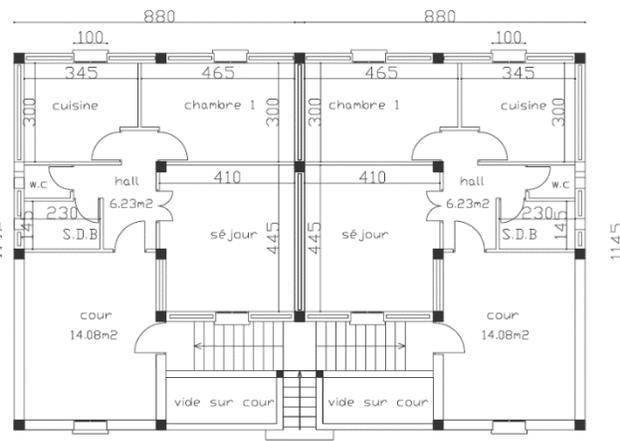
PLAN TYPE DES LOGEMENTS REALISES, PLAN DU RDC (02 F3)
